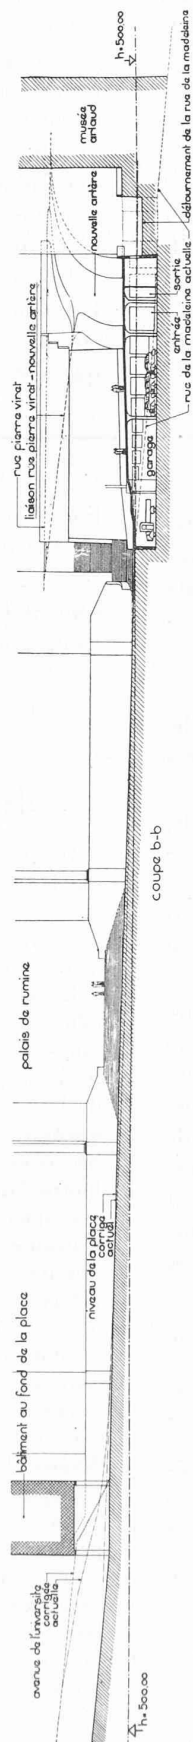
Coupe b-b (voir plan). — Echelle 1 : 1000.
